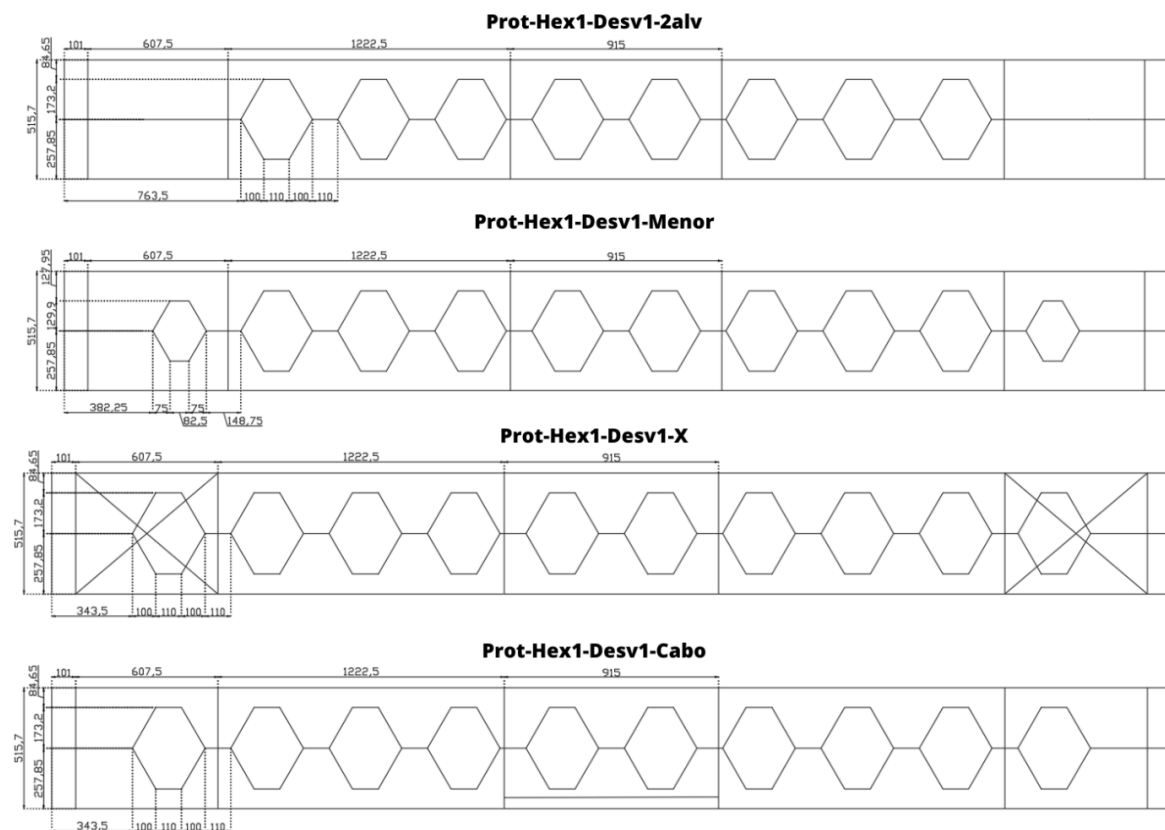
Dimensões das vigas com alvéolos hexagonais, um par extra de desviadores e alterações na viga.
